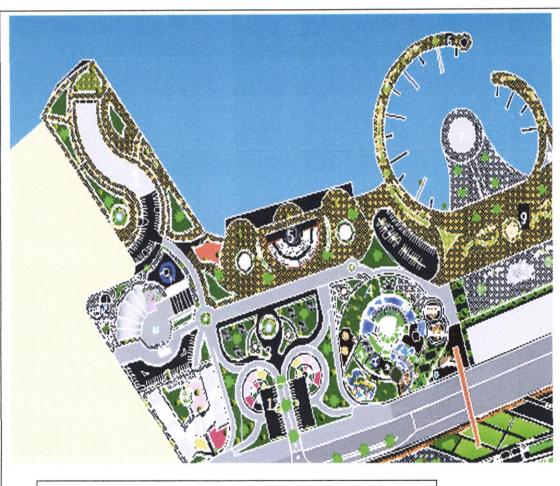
vue sur le plan d'Aménagement, source auteur 2017
